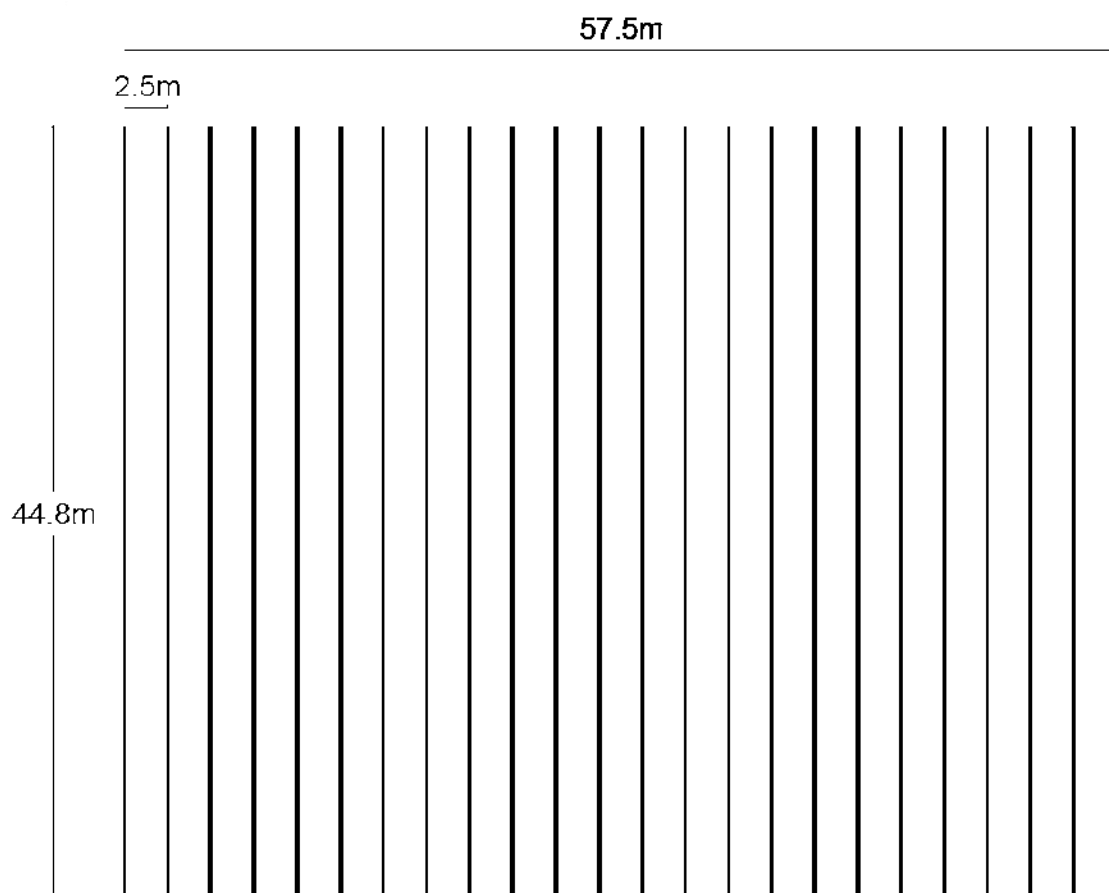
(k) Dimensiones de la cubierta vista en planta, (metros)
